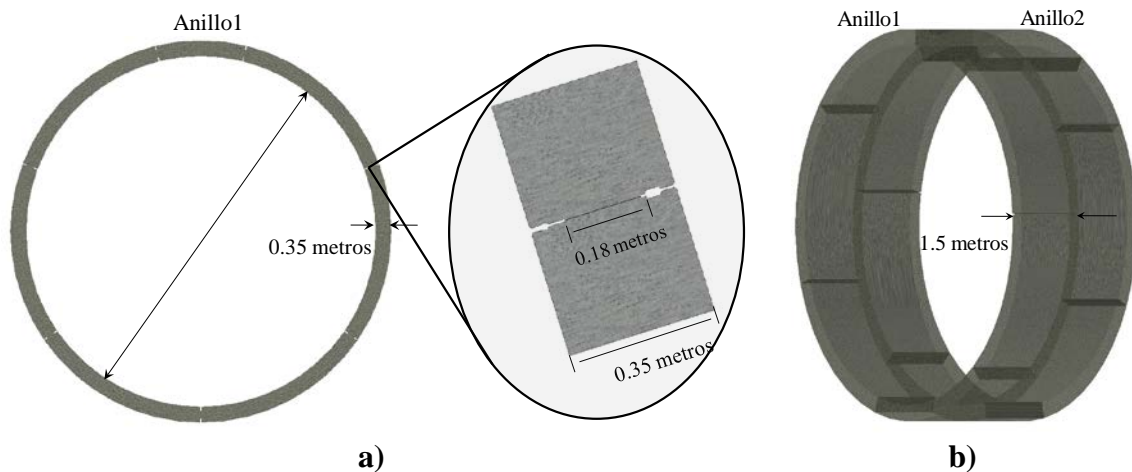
Geometría de un túnel típico construido en la ciudad de México: a) vista frontal; b) vista isométrica
